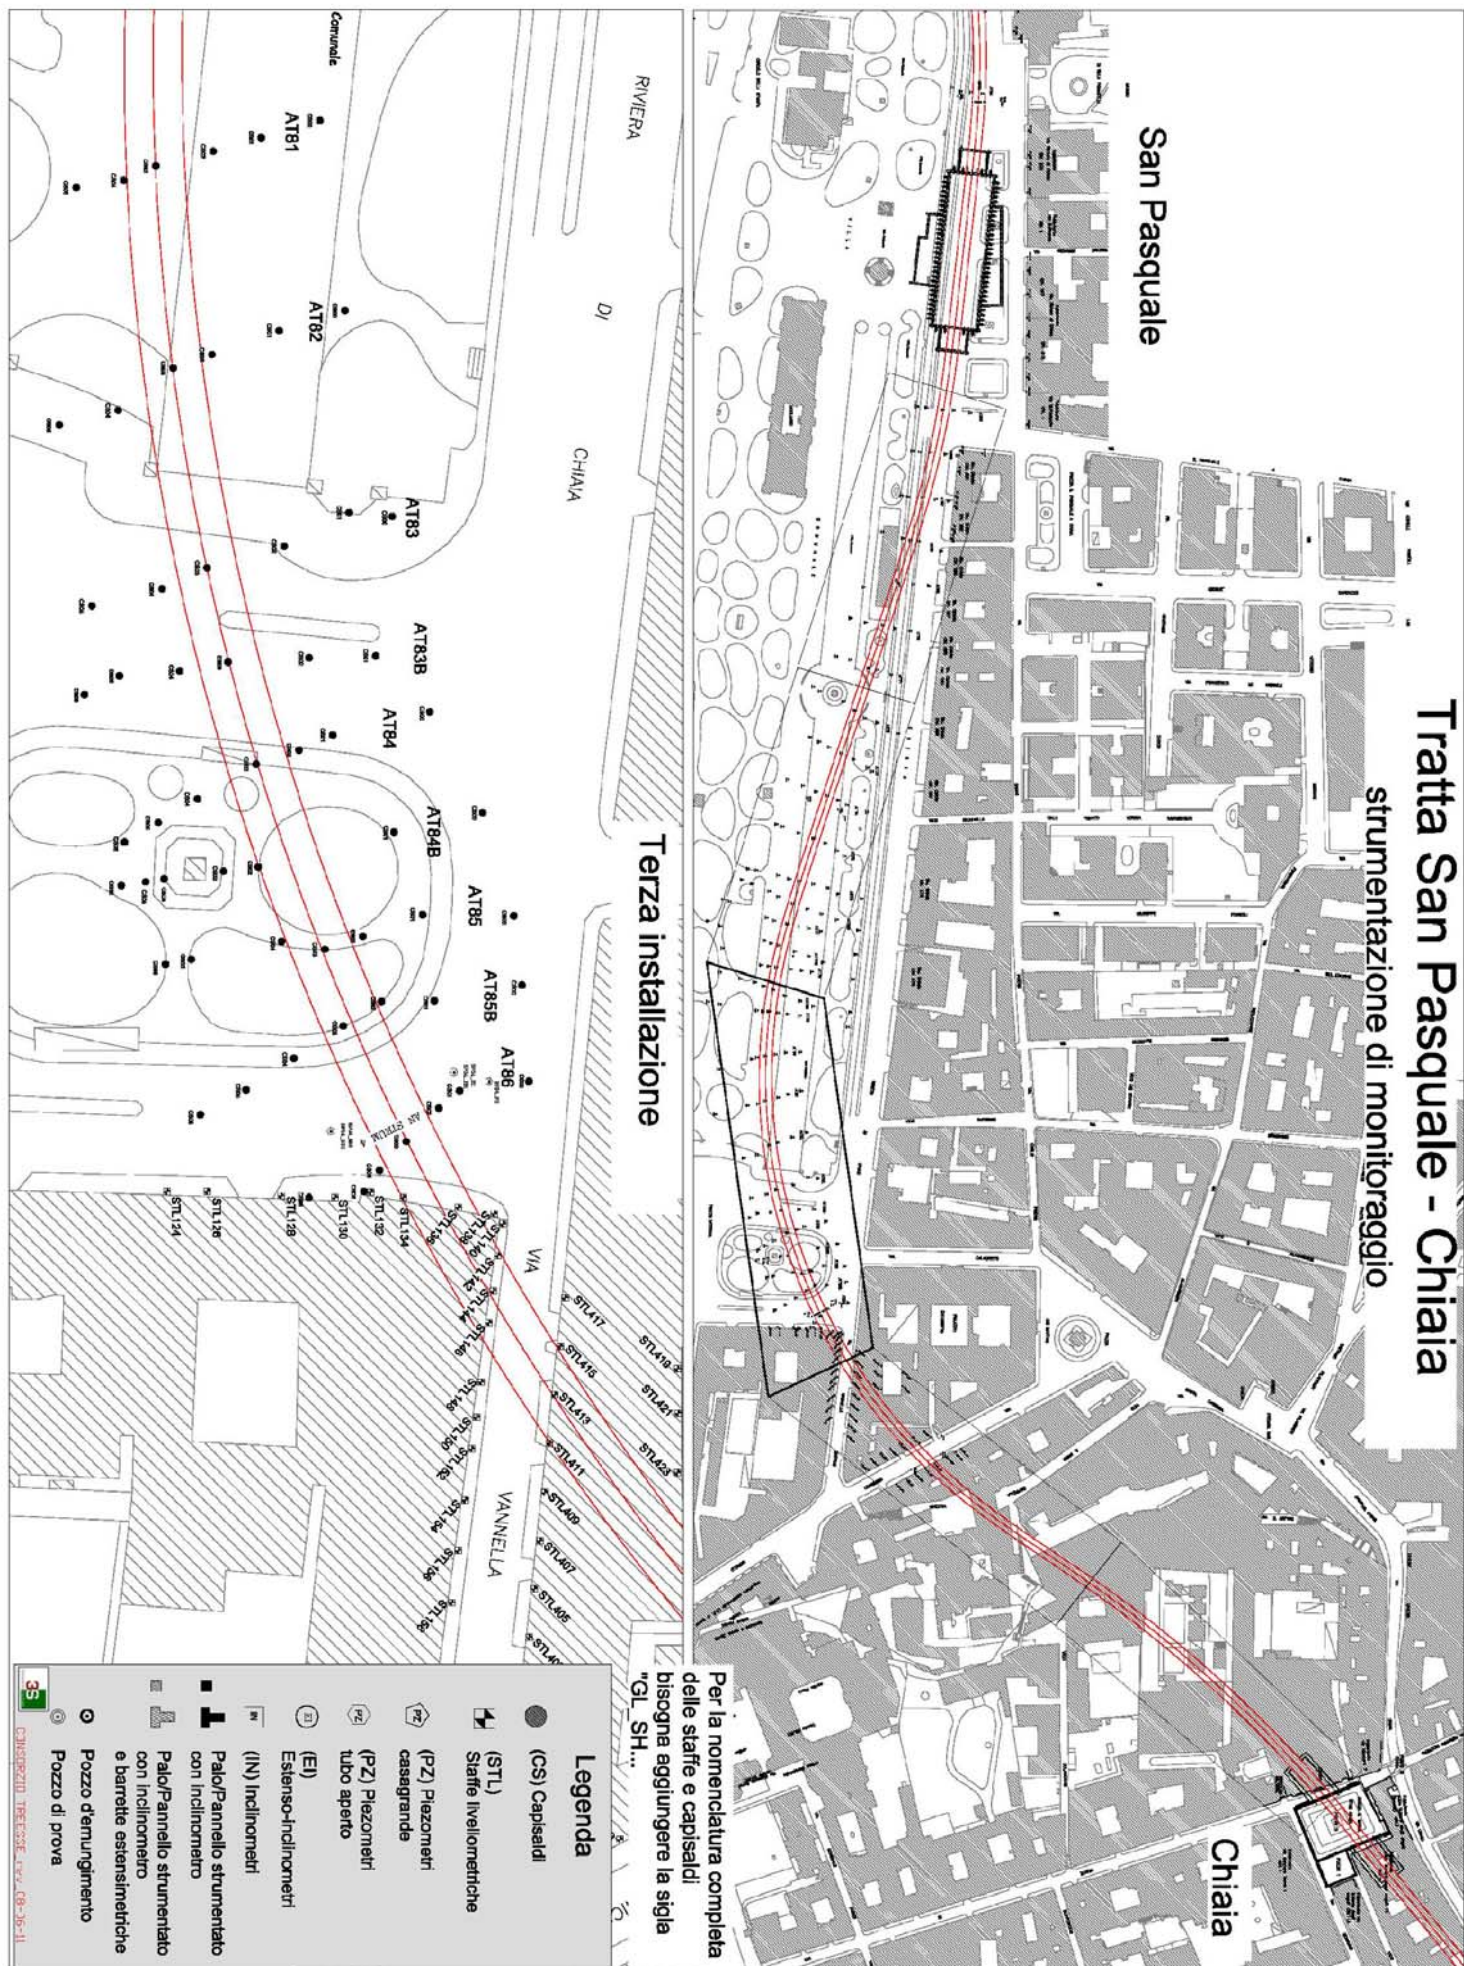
Planimetria tratta San Pasquale - Chiaia, raffigurante la disposizione della terza installazione della strumentazione di monitoraggio.
